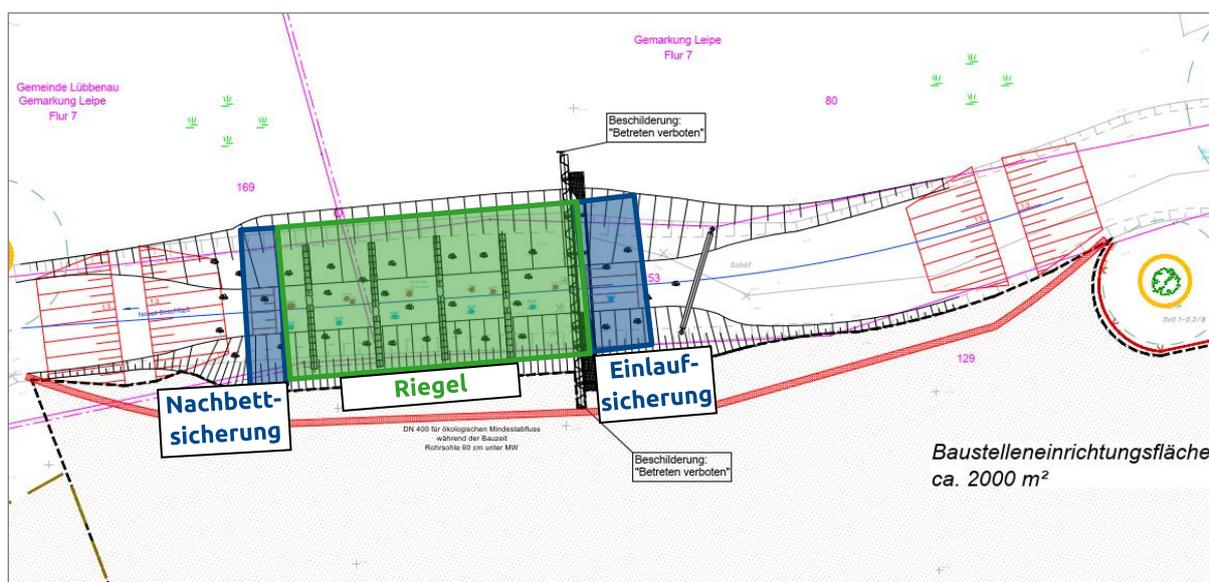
Wehr 46 - Überblick zu benötigten Wasserhaltungen (Lageplan aus /P3/)
